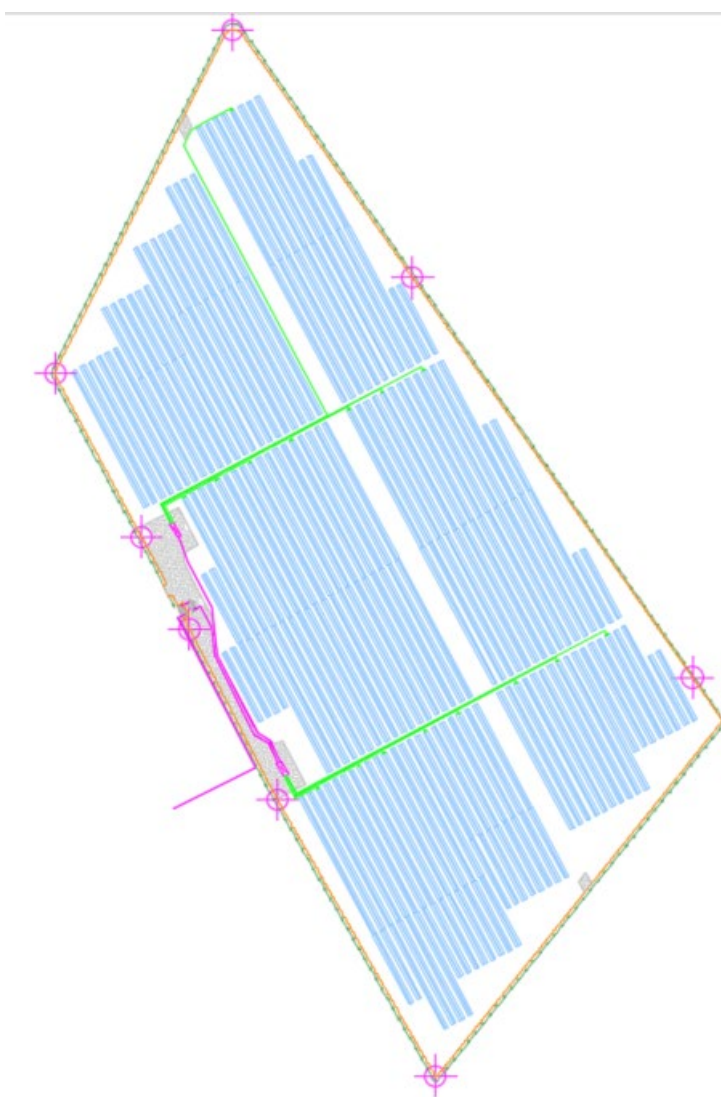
Layout impianto – Rif – RV-FV-ER-37-D11-00-Layout impianto e successive modifiche
